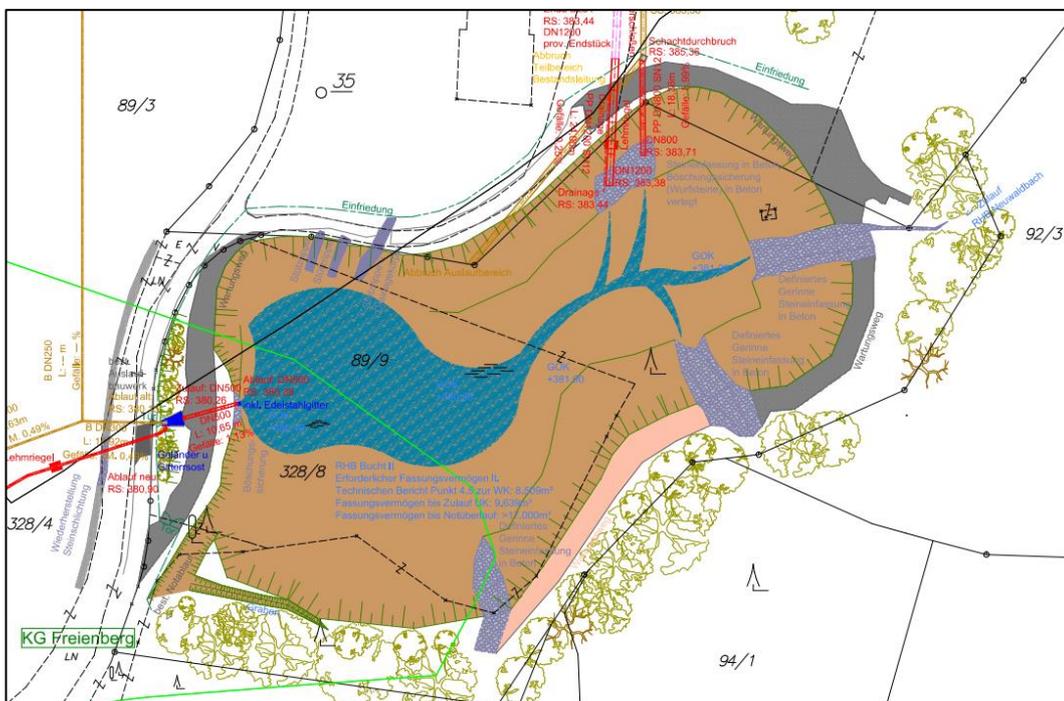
Vergrößerung RHB-Bucht II, Detailprojekt 2018, Lageplan Spener Ziviltechniker KG
